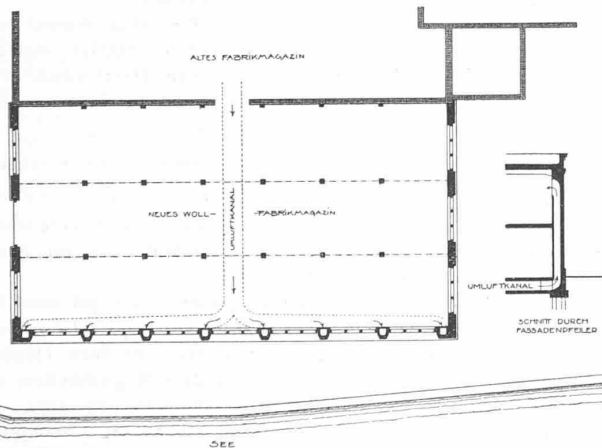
Erdgeschoss-Grundriss und Schnitt. — 1:500.
